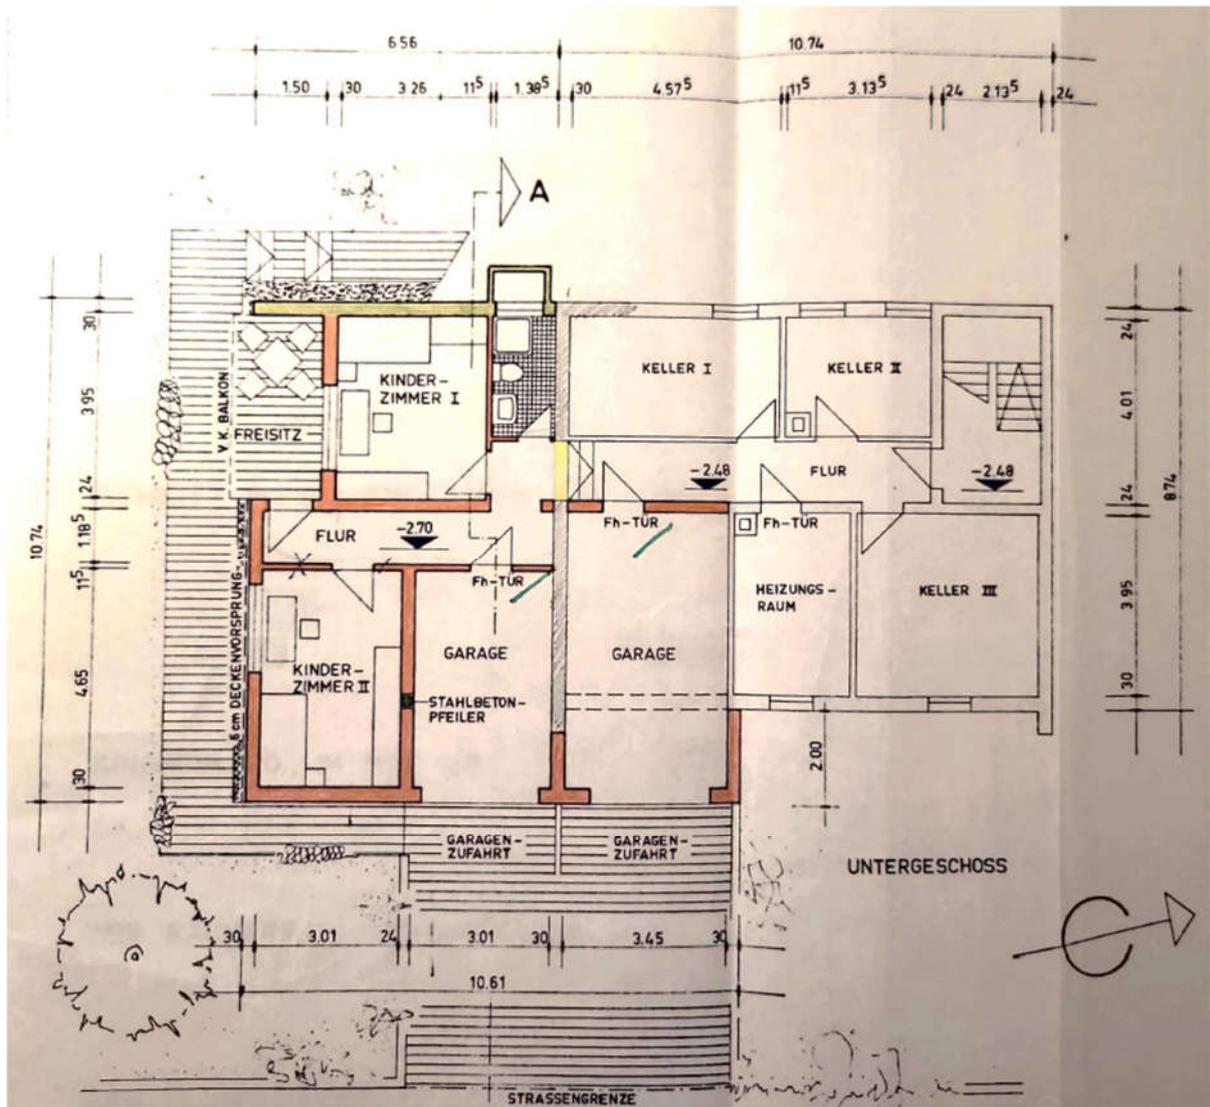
Grundriss Untergeschoss mit Erweiterung
